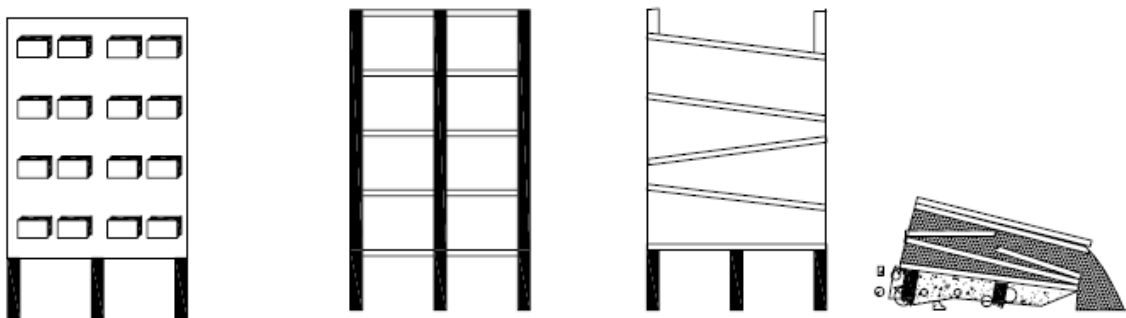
Proceso que produce un modo de colapso tipo apilamiento.
